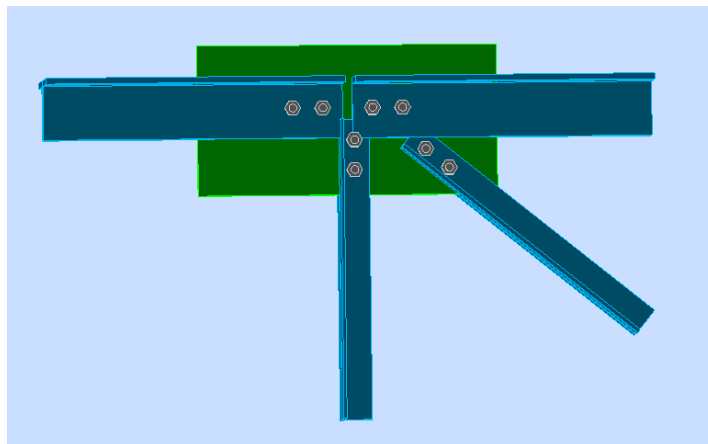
schéma d'assemblage de la diagonale sur le gousset
